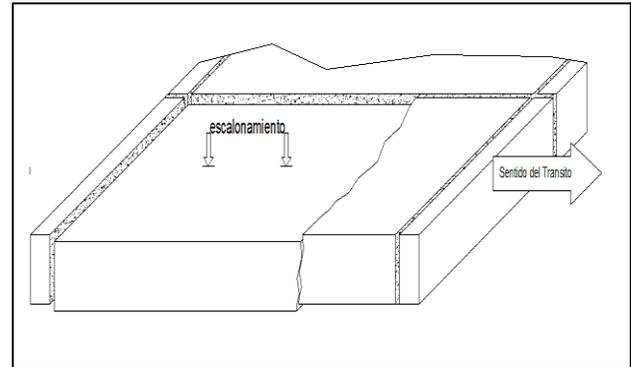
Esquema escalonamiento de juntas y grietas (Autor, 2013).
